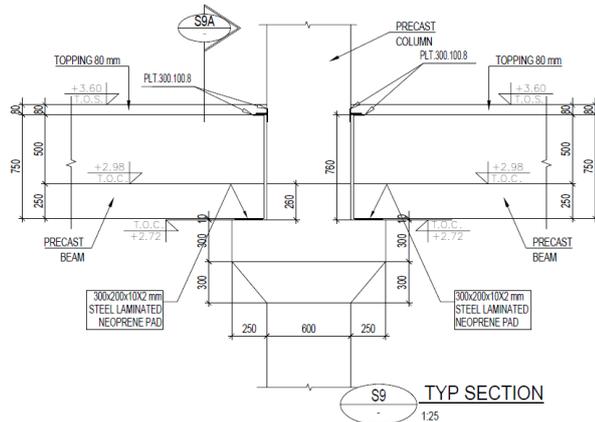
Detalle de apoyo de vigas prefabricadas en pilares prefabricados
